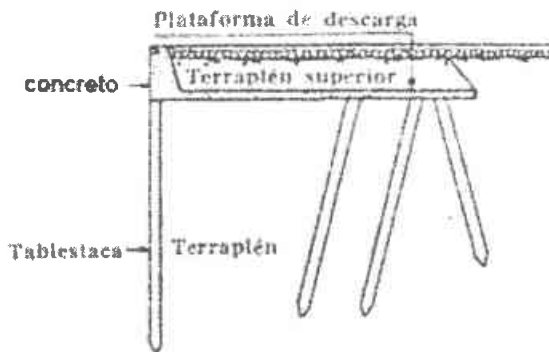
Muro de muelle con cortina plana simple de tablestacas.
